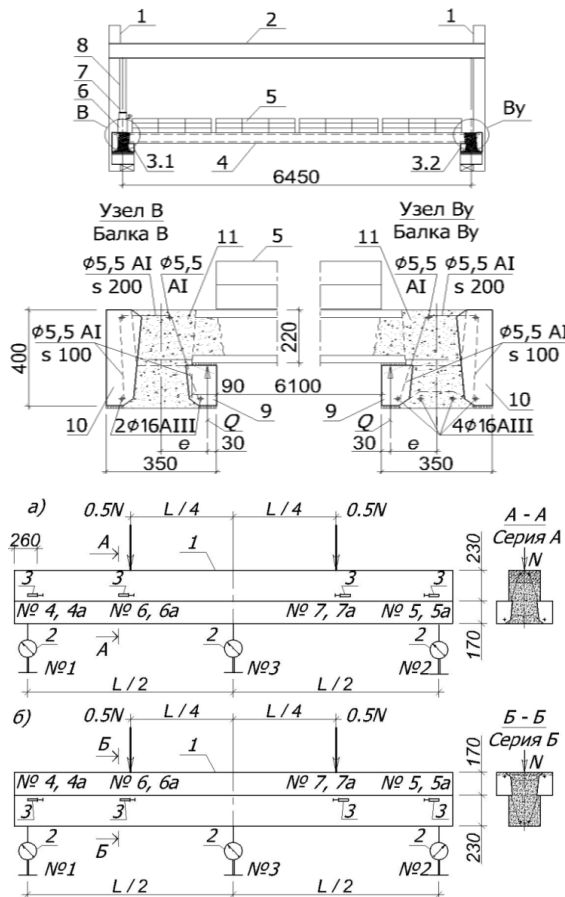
Схема испытания пары СбМт балок серии В, поясов наружных стен: 1 - рама испытательного стенда; 2 - вспомогательная балка стенда; 3.1 - СбМт балка пояса В; 3.2 - тоже - Ву; 4 - настил из круглопустотных панелей перекрытия; 5 - постоянная нагрузка; 6 - траверса на подвижных опорах; 7 - гидравлический домкрат; 8 - насадка; 9 - опорная ветвьбалка; 10 - ограждающая ветвьбалка; 11 - монолитный сердечник. [Разработка автора].
